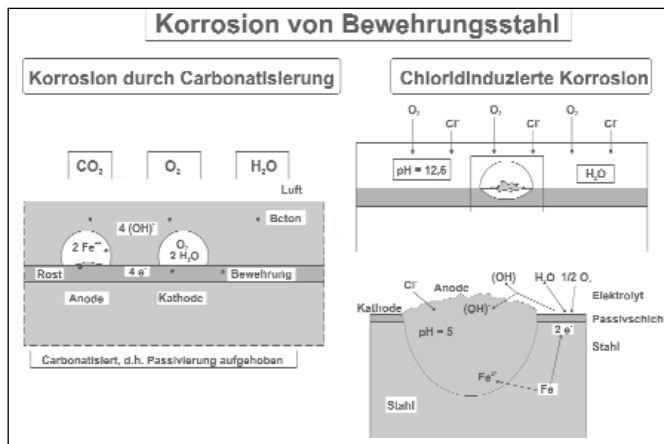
Mechanismen für Bewehrungsstahlkorrosion
